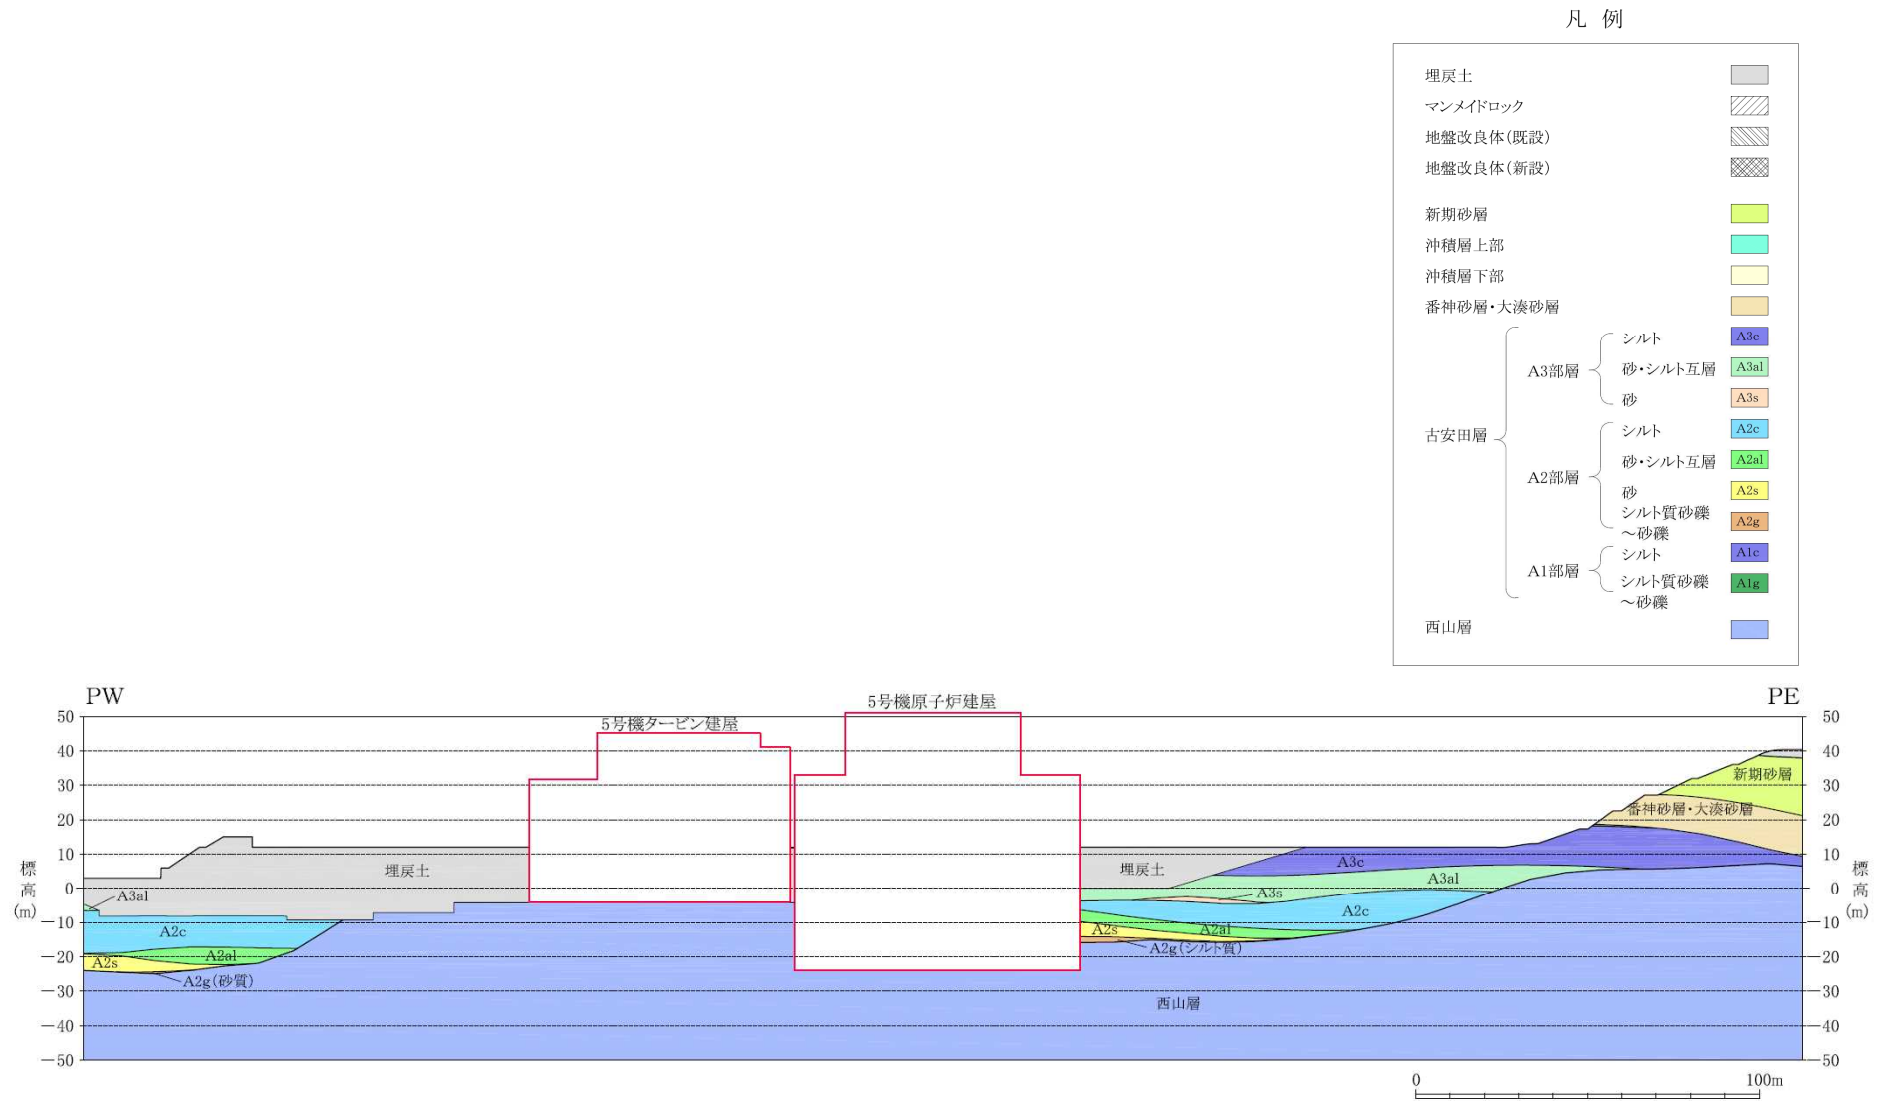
汀線直交 地質断面図 (5号機原子炉建屋炉心中央) (H-H断面)
